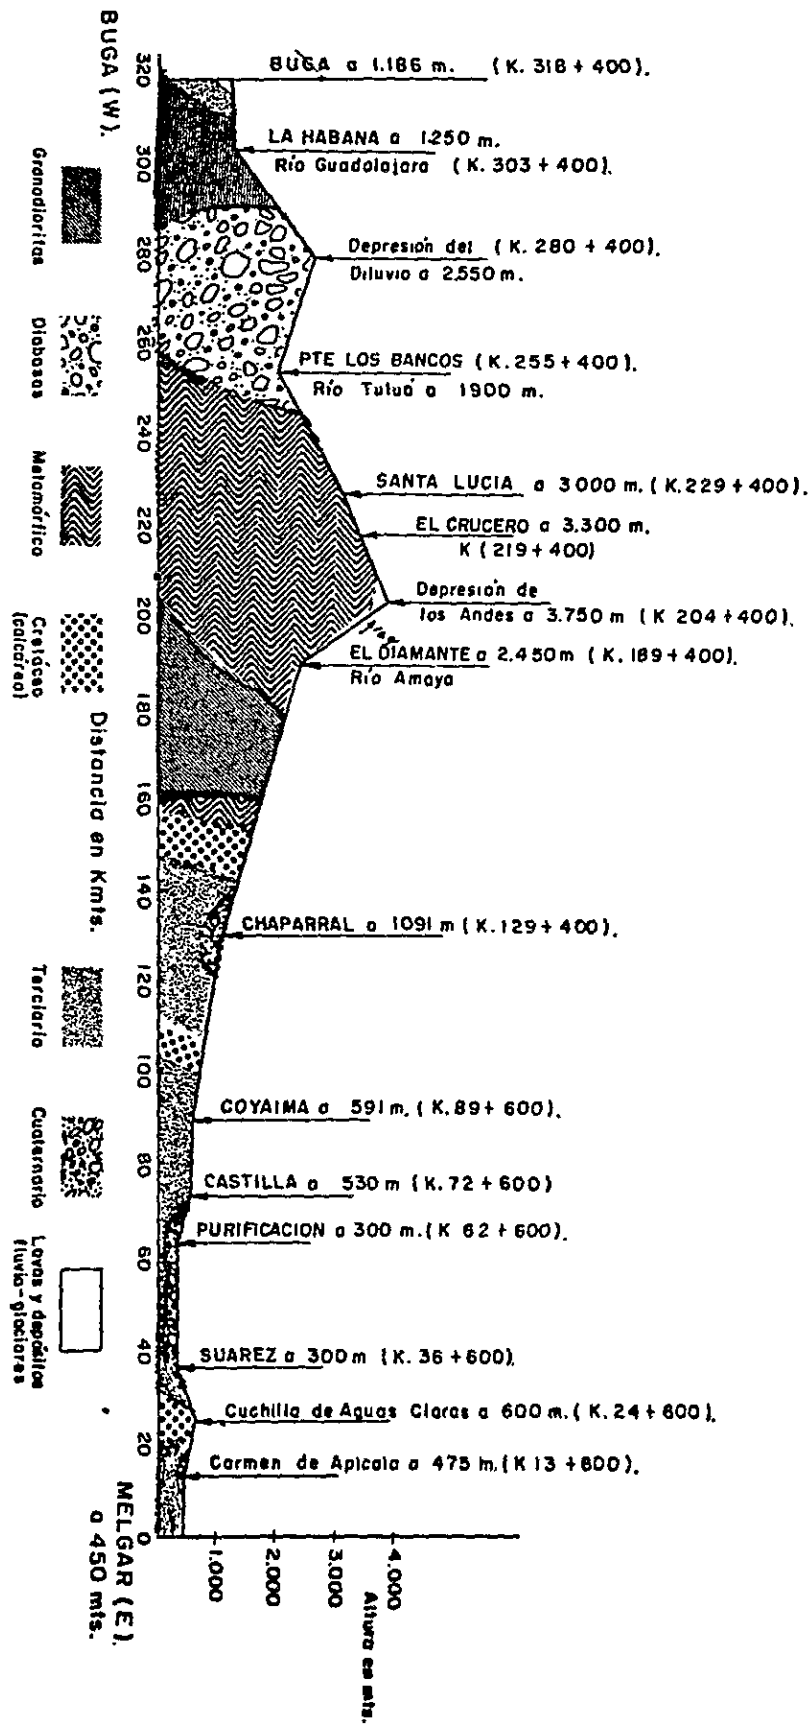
PERFIL LONGITUDINAL DE LA ALTERNATIVA 3 DEL PROYECTO MELGAR-BUGA
